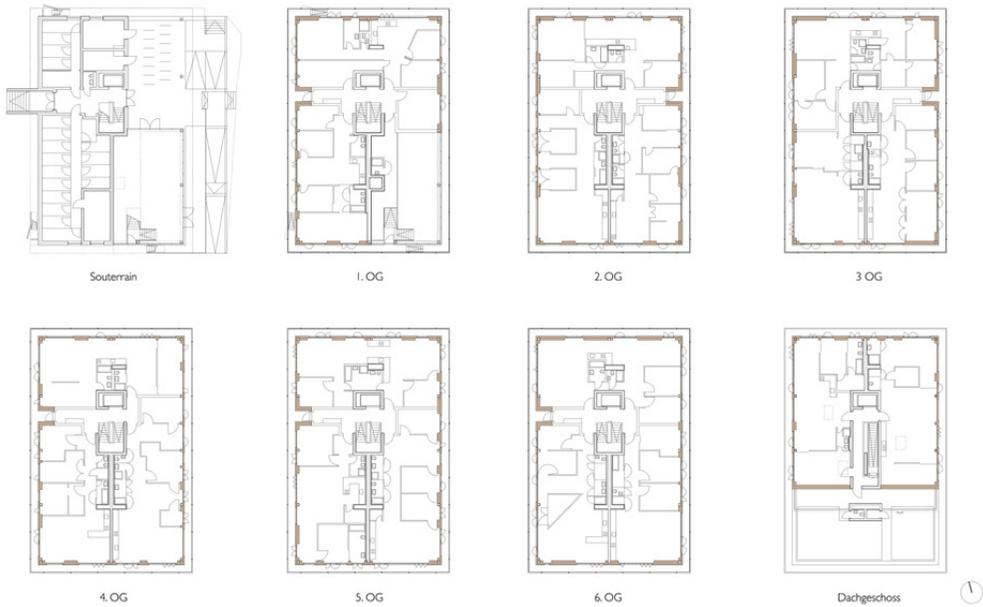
R50, Grundrisse der Wohnungen
